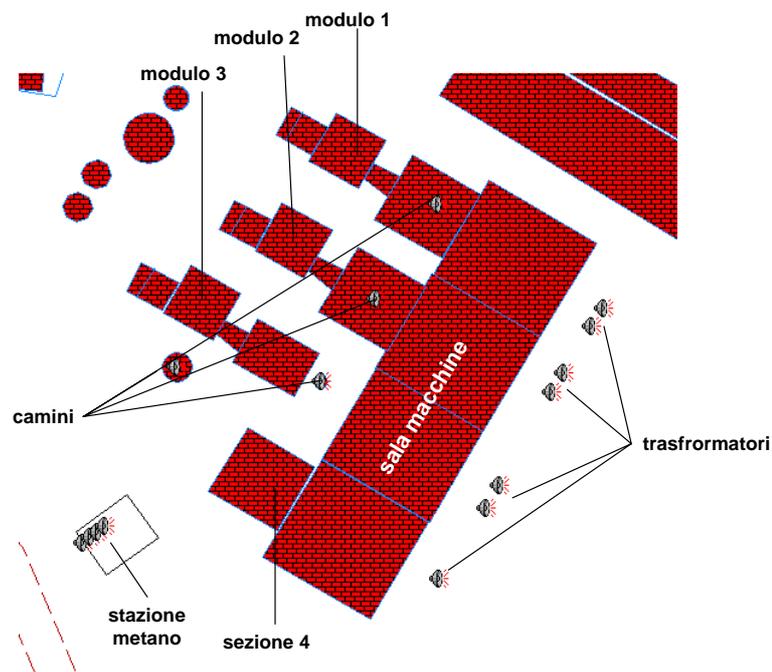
/2 - Layout dell'impianto nella situazione attuale (3 cc + sez 4)
